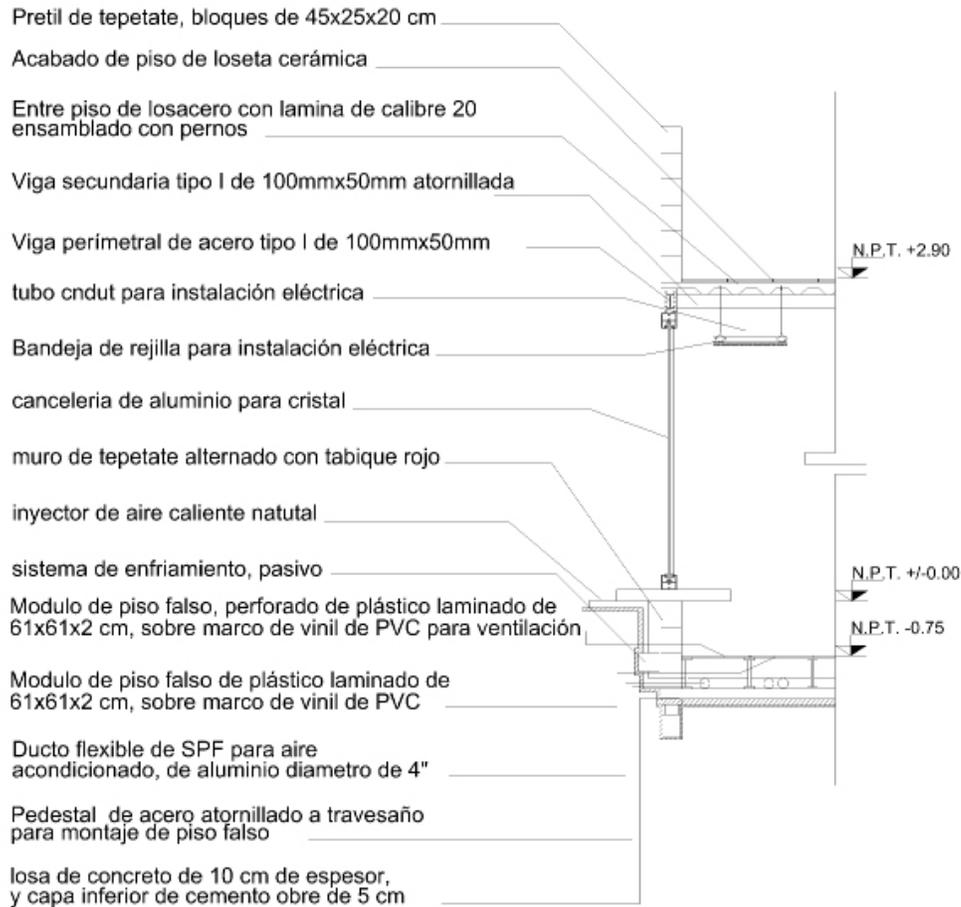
Corte por fachada, Aplicación de sistema estructural, materiales y ventilación.
